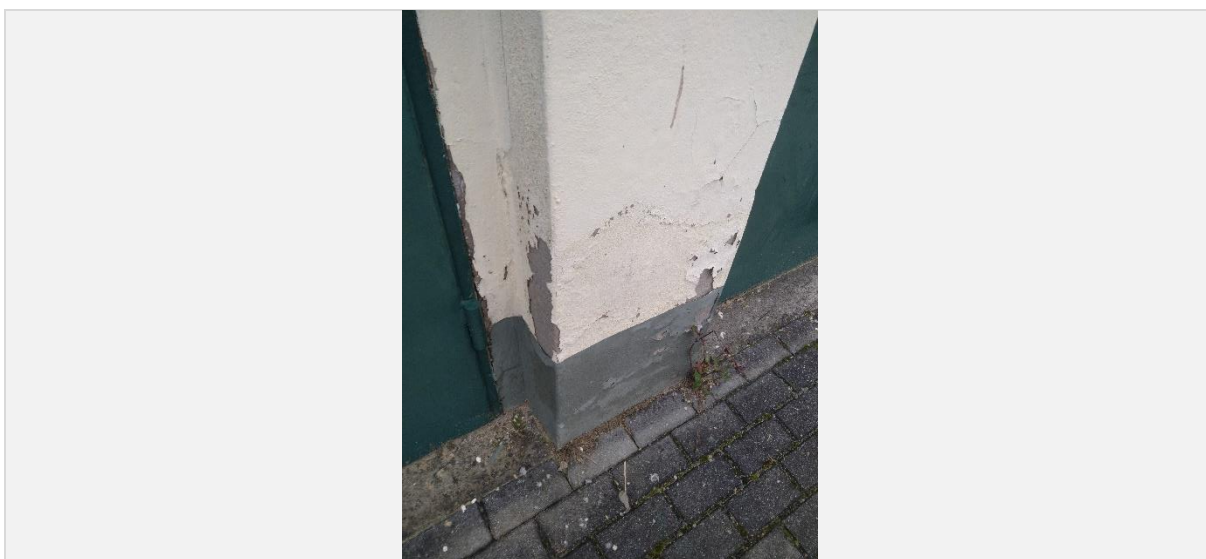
Elewacja frontowa – odspojenia, mocna degradacja wyprawy tynkarskiej pomiędzy bramami garażowymi
